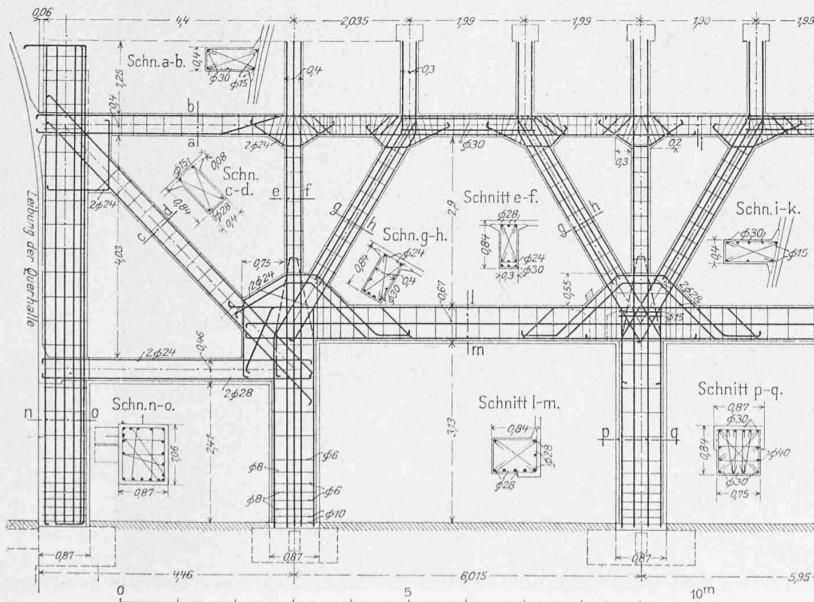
Konstruktion der Schalterhallenwand, Ansicht und Schnitte (etwa 1 : 120).
